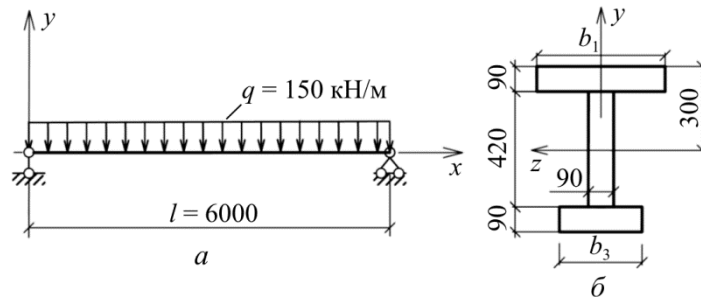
К расчету балки: а – расчетная схема; б – поперечное сечение
